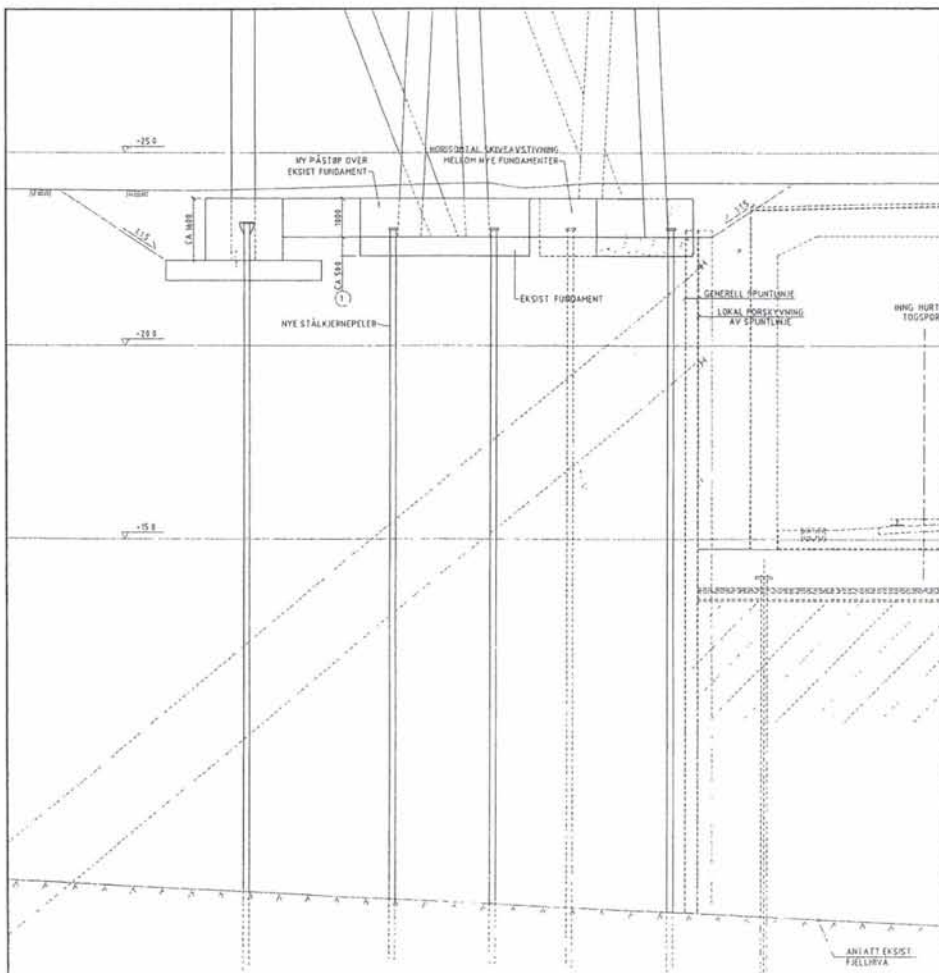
Snitt, oppriss og plan for stegrad 1 og 2 gjennom spunt under høyspent
